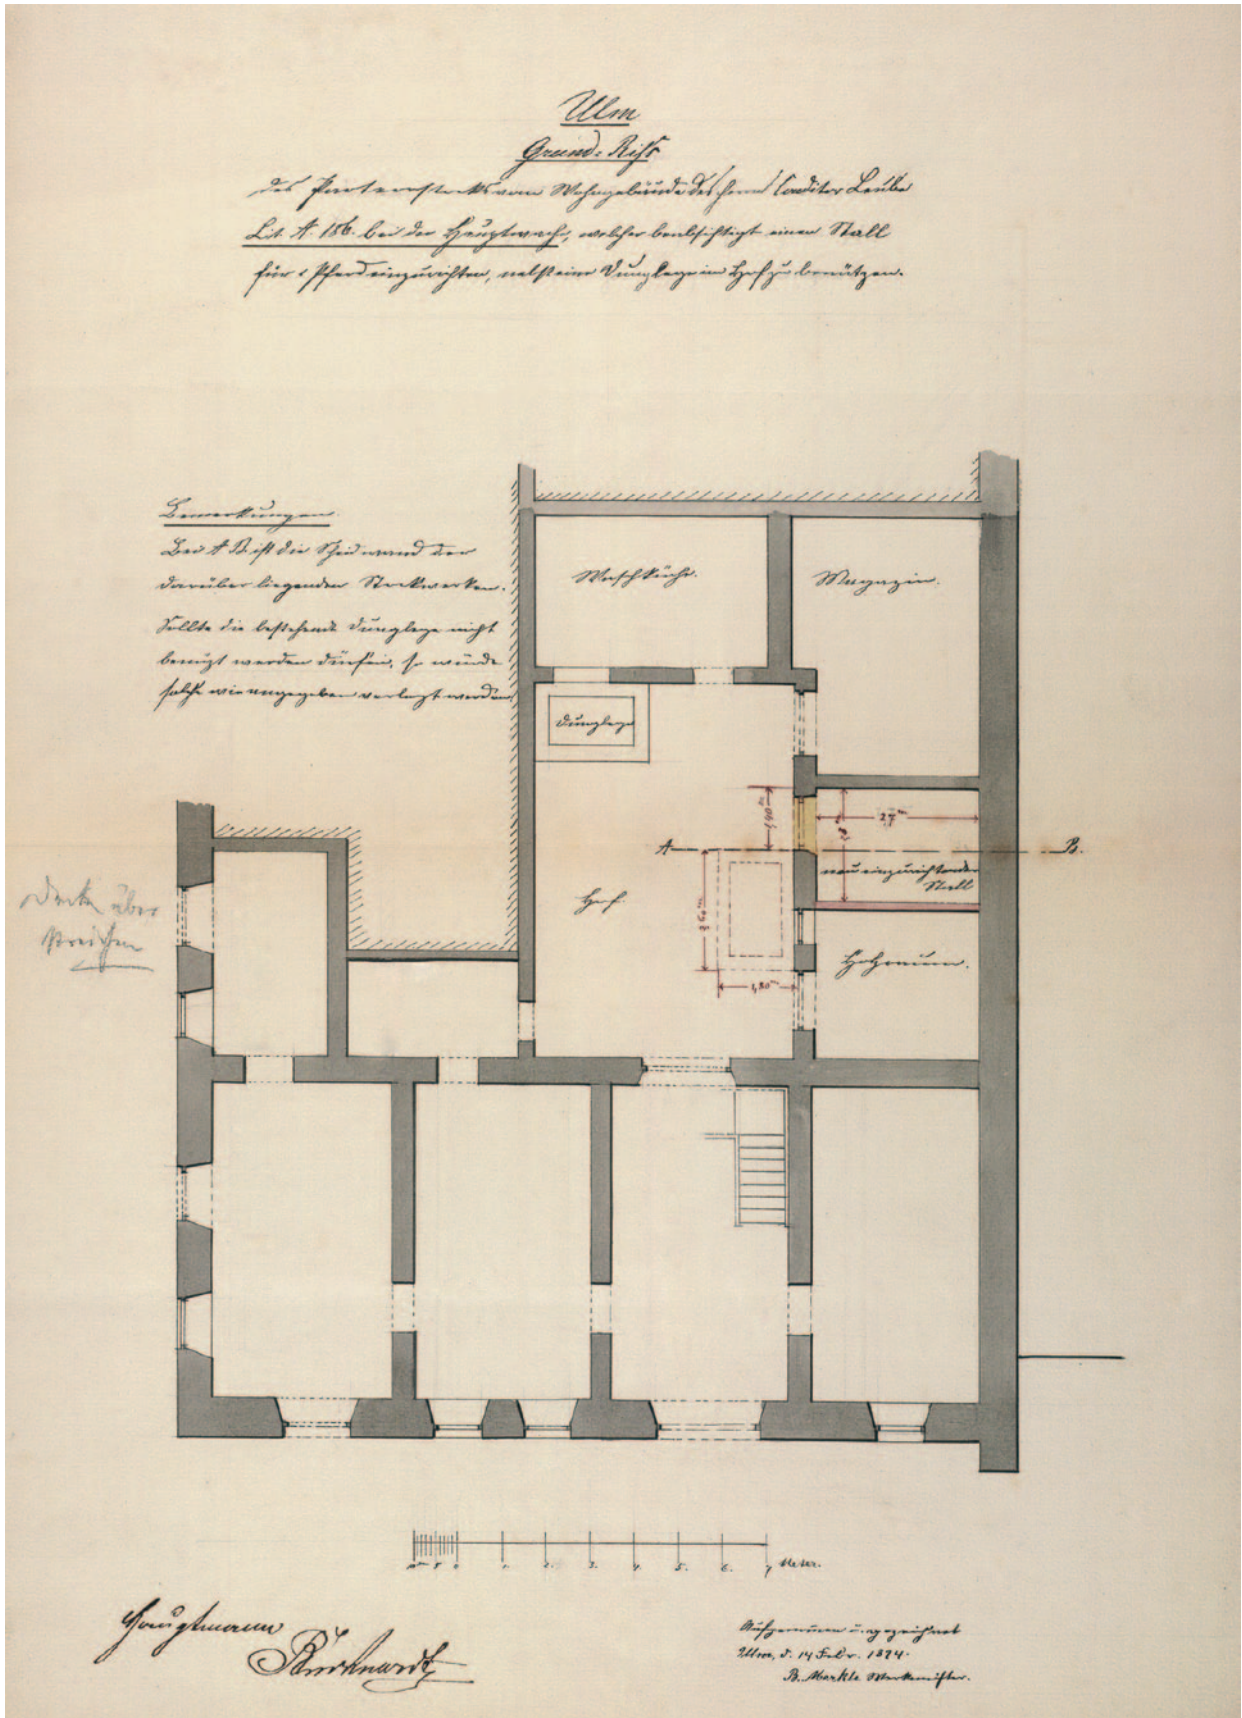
Gebäude Lange Straße 10 (A 186), Erdgeschossgrundriss, Plan zur Einrichtung eines Pferdestalls mit Dunglege für Hauptmann Burkhardt im Jahre 1875.
